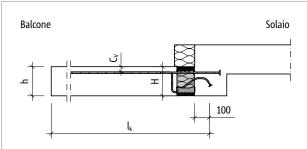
Schöck Isokorb® XT tipo KL-U: schema statico
